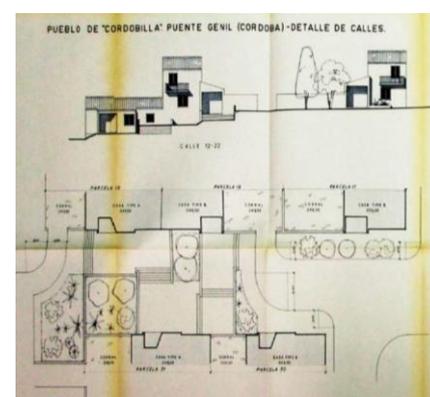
Tipo B. Detalle de planta y alzado de la calle.
